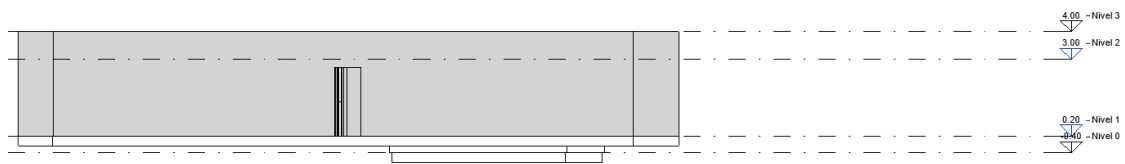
Alzado Este modelo levantamiento con iPhone. Fuente: elaboración propia.
